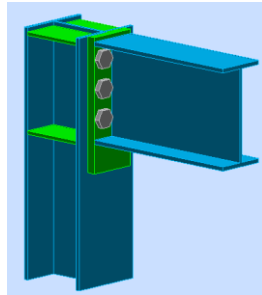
Pormenor da Ligação Coluna-Travessa (HEA 180 – IPE 240).
